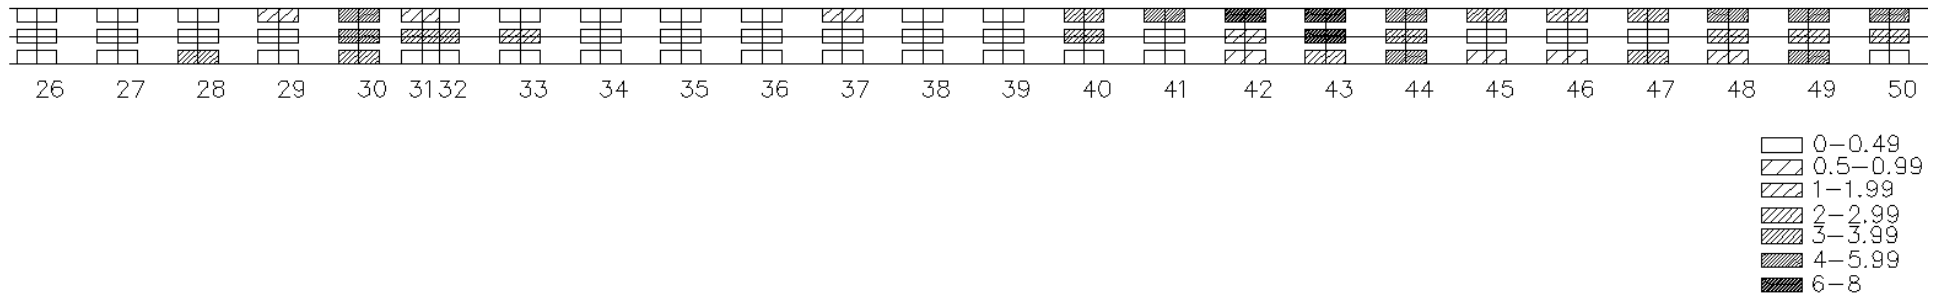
Frästiefen bei Tangenten und quadratischen Parabeln und Verfahrensplan Typ C, Grundriss, Stationen 26-50
